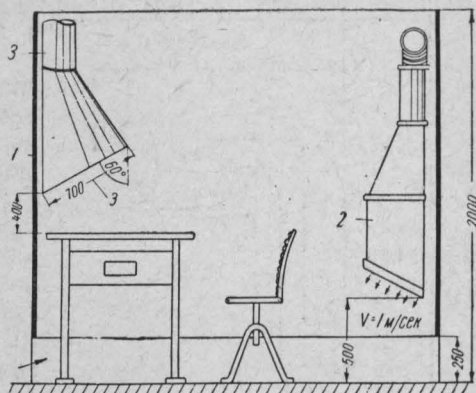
Оборудование кабины сварщика с приточно-вытяжной вентиляцией
